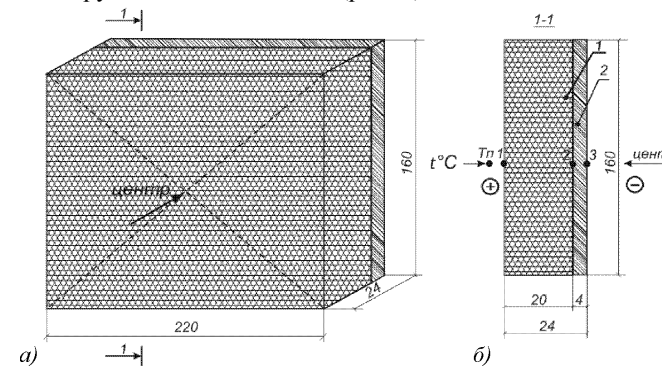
Загальні розміри дослідного зразка та схема розташування термопар: а) габаритні розміри; б) розріз: 1 – вермикуліто-силікатна плита; 2 – листова сталь Ст-5; T_n – термопара в печі; 1 – на обігрівальній поверхні, 2 – між шарами конструкції, 3 – на необігрівальній поверхні
